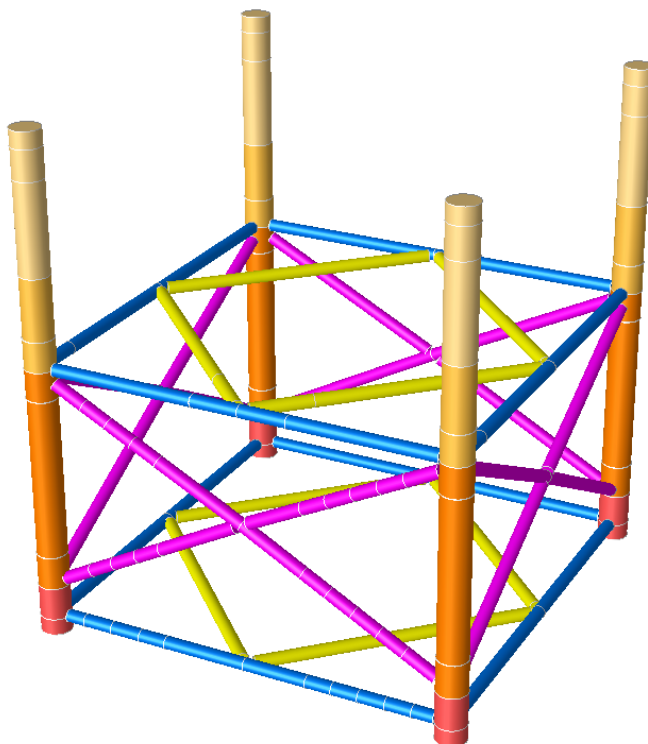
Sistema di irrigidimento strutturale (jacket)
